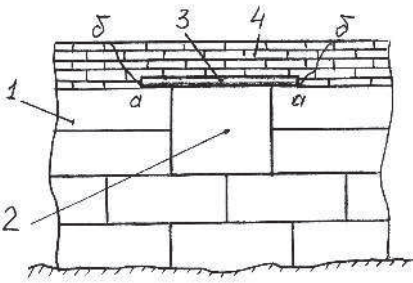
Разрушение цоколя над проемом: 1 – фундаментные блоки; 2 – проем оконный; 3 – перемычка; 4 – кирпич; аб – трещины разрушения
